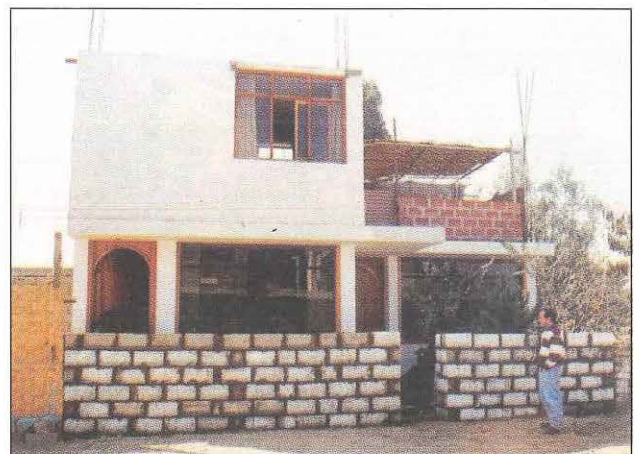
y 27. Viviendas de albañilería y concreto armado con daño irreparable, Tacna.
